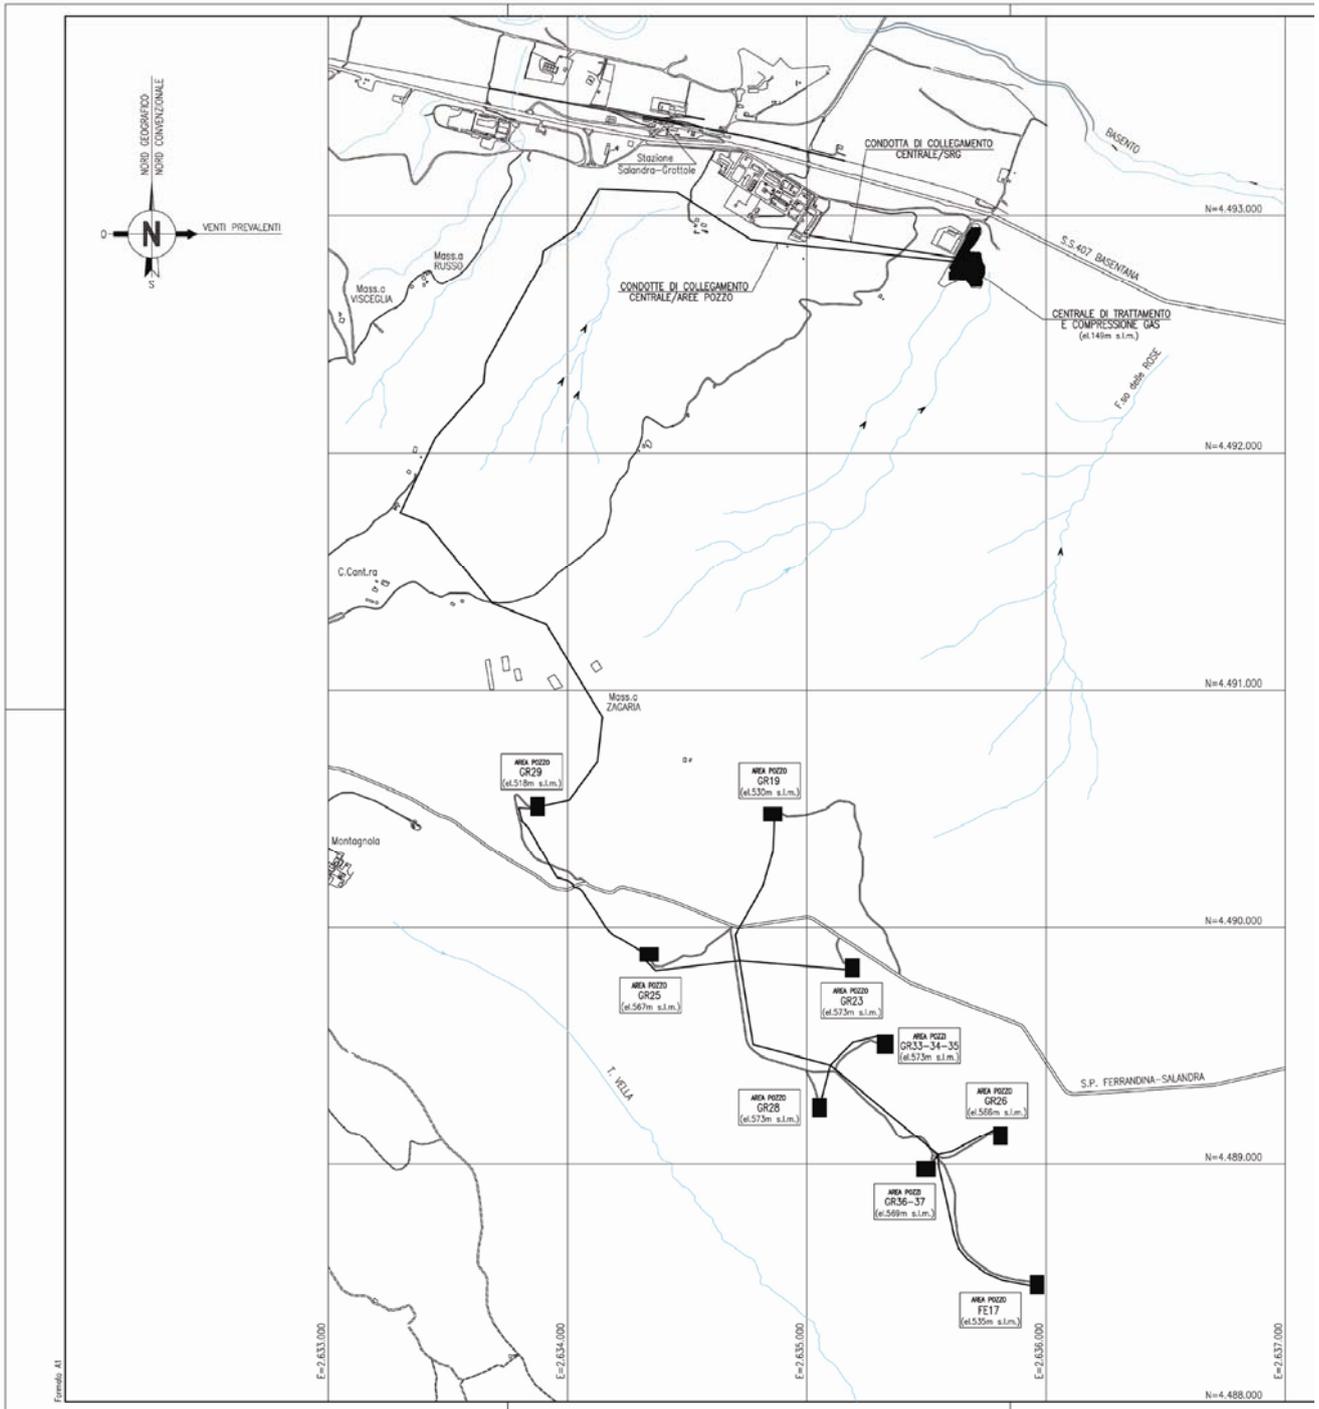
Stralcio planimetrico con ubicazione delle aree pozzo del campo di Grottole/Ferrandina e dell'esistente metanodotto di collegamento tra il giacimento e la Centrale di Compressione e Trattamento gas.
